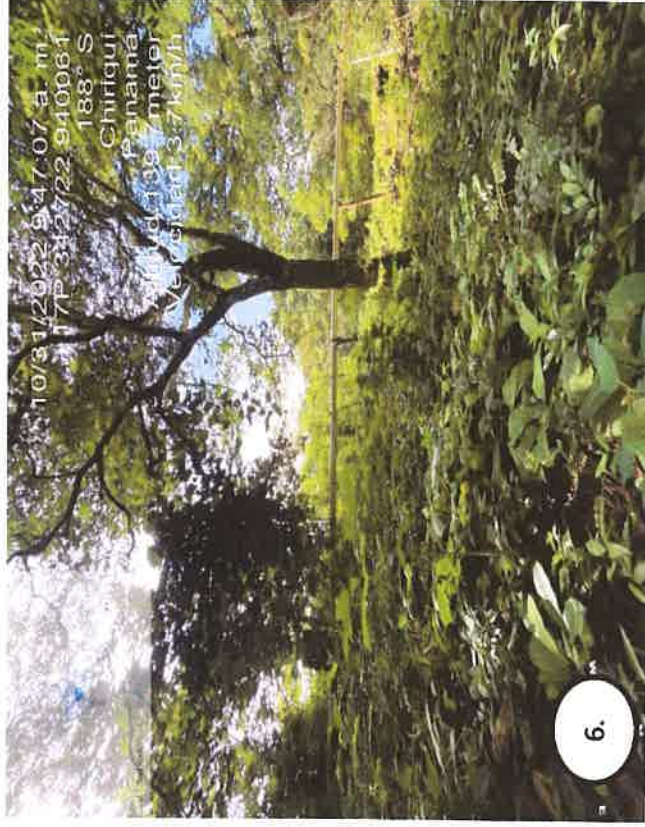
Vista de la tubería de conducción suspendida observada durante el recorrido en campo.
